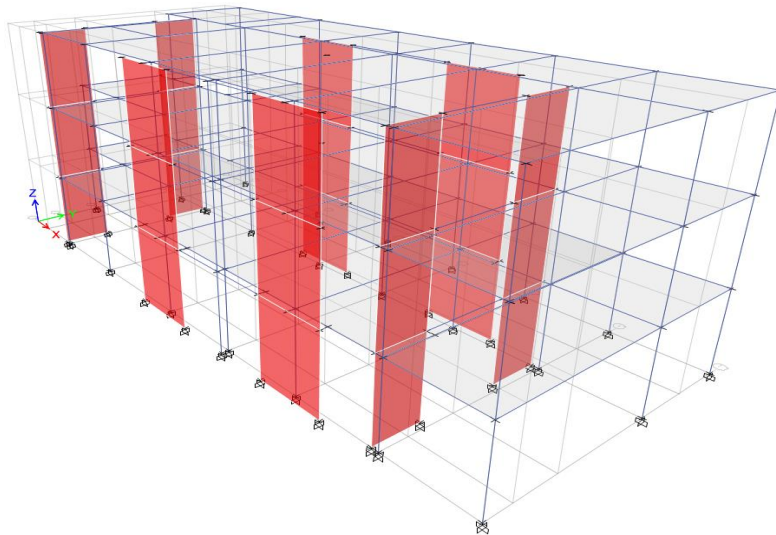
Vista 2 en planta y modelo tridimensional en ETABS.
